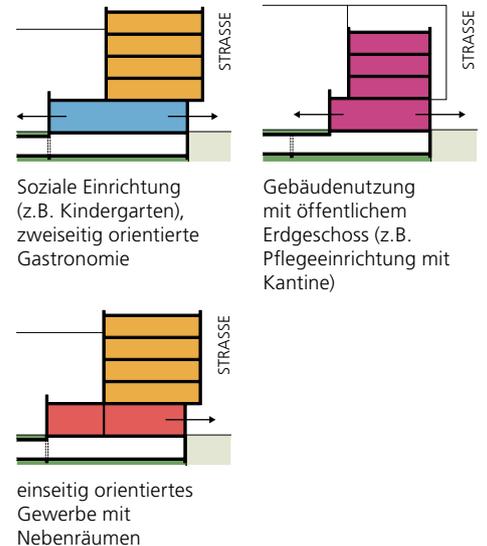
Schema: Erdgeschossstruktur zur Parkterrasse (Rheinstraße) mit beispielhaften Nutzungen
